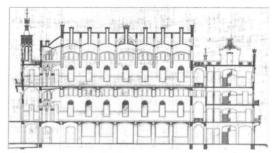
Sección longitudinal del pabellón de San Manuel (AHSCP)
